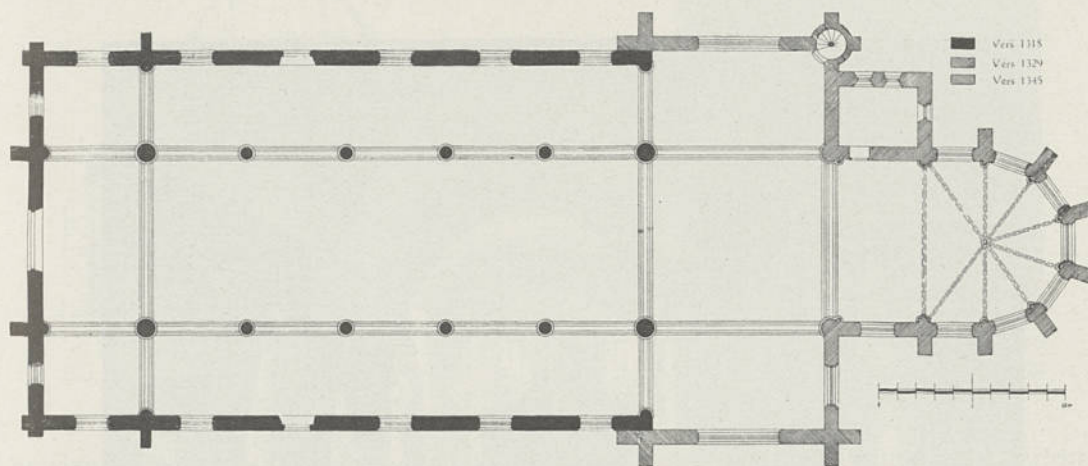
Diest, Eglise du Béguinage, plan terrier, reconstitution
